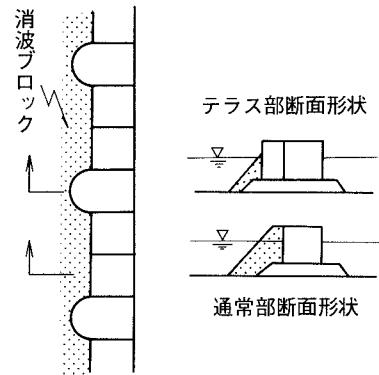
親水テラス付き消波ブロック被覆堤(左:平面図、右:断面図)
